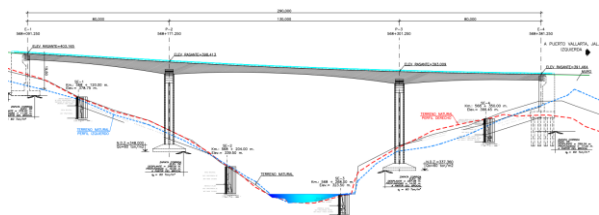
Alzado del Puente Las Truchas en el proyecto licitado.
